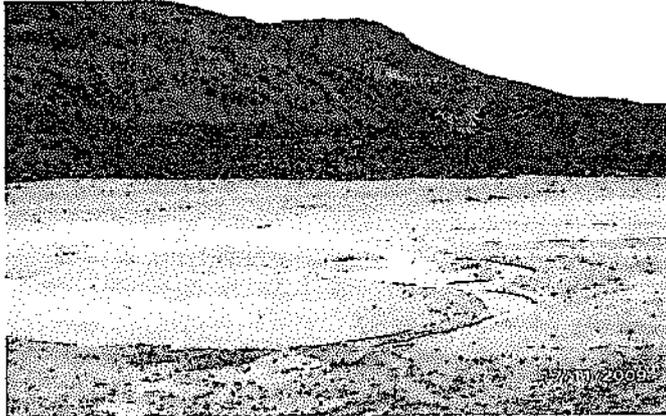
Sector Norte del depósito de relaves Vizcacha. Obsérvese el relave completamente seco. Durante la Supervisión, este depósito estuvo paralizado por encontrarse la planta en mantenimiento.
